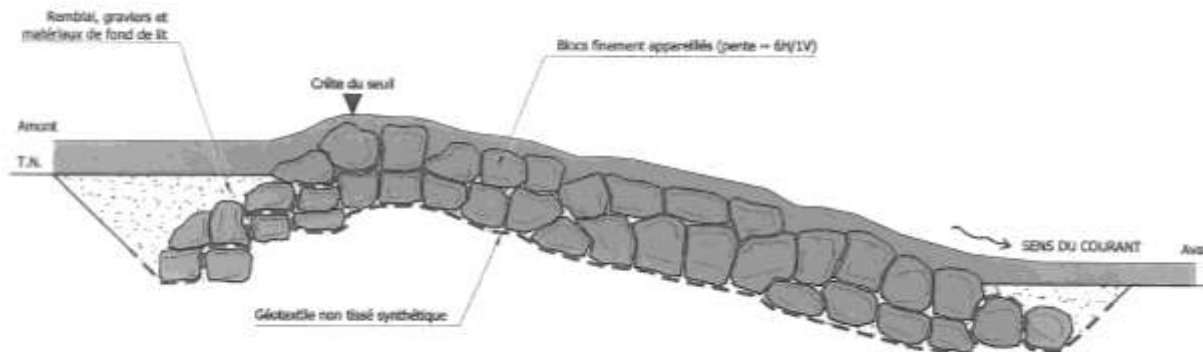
Profil en long d'une rampe de fond (SILENE BIOTEC)
